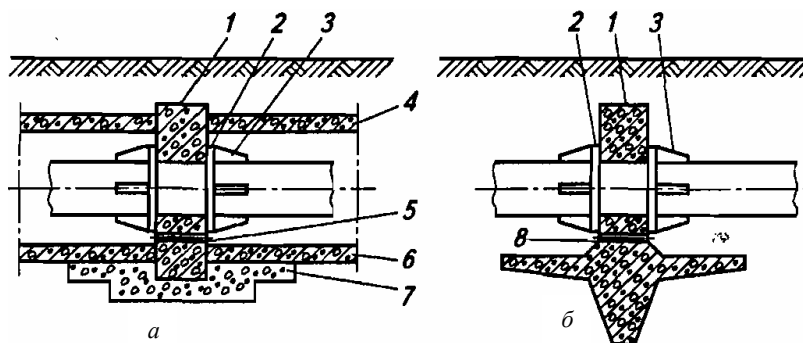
Щитовая неподвижная опора при установке: *а*) в непроходном канале; *б*) в бесканальной теплотрассе; 1 – железобетонная щитовая стенка; 2 – асбестовая прокладка; 3 – лобовая опора; 4 – перекрытие; 5 – дренажное отверстие; 6 – дно канала; 7 – опорная бетонная подушка; 8 – отверстие для дренажной трубы
